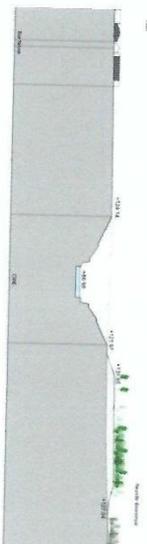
Coupe en plan de Ytres, source AFSSA/ARF
